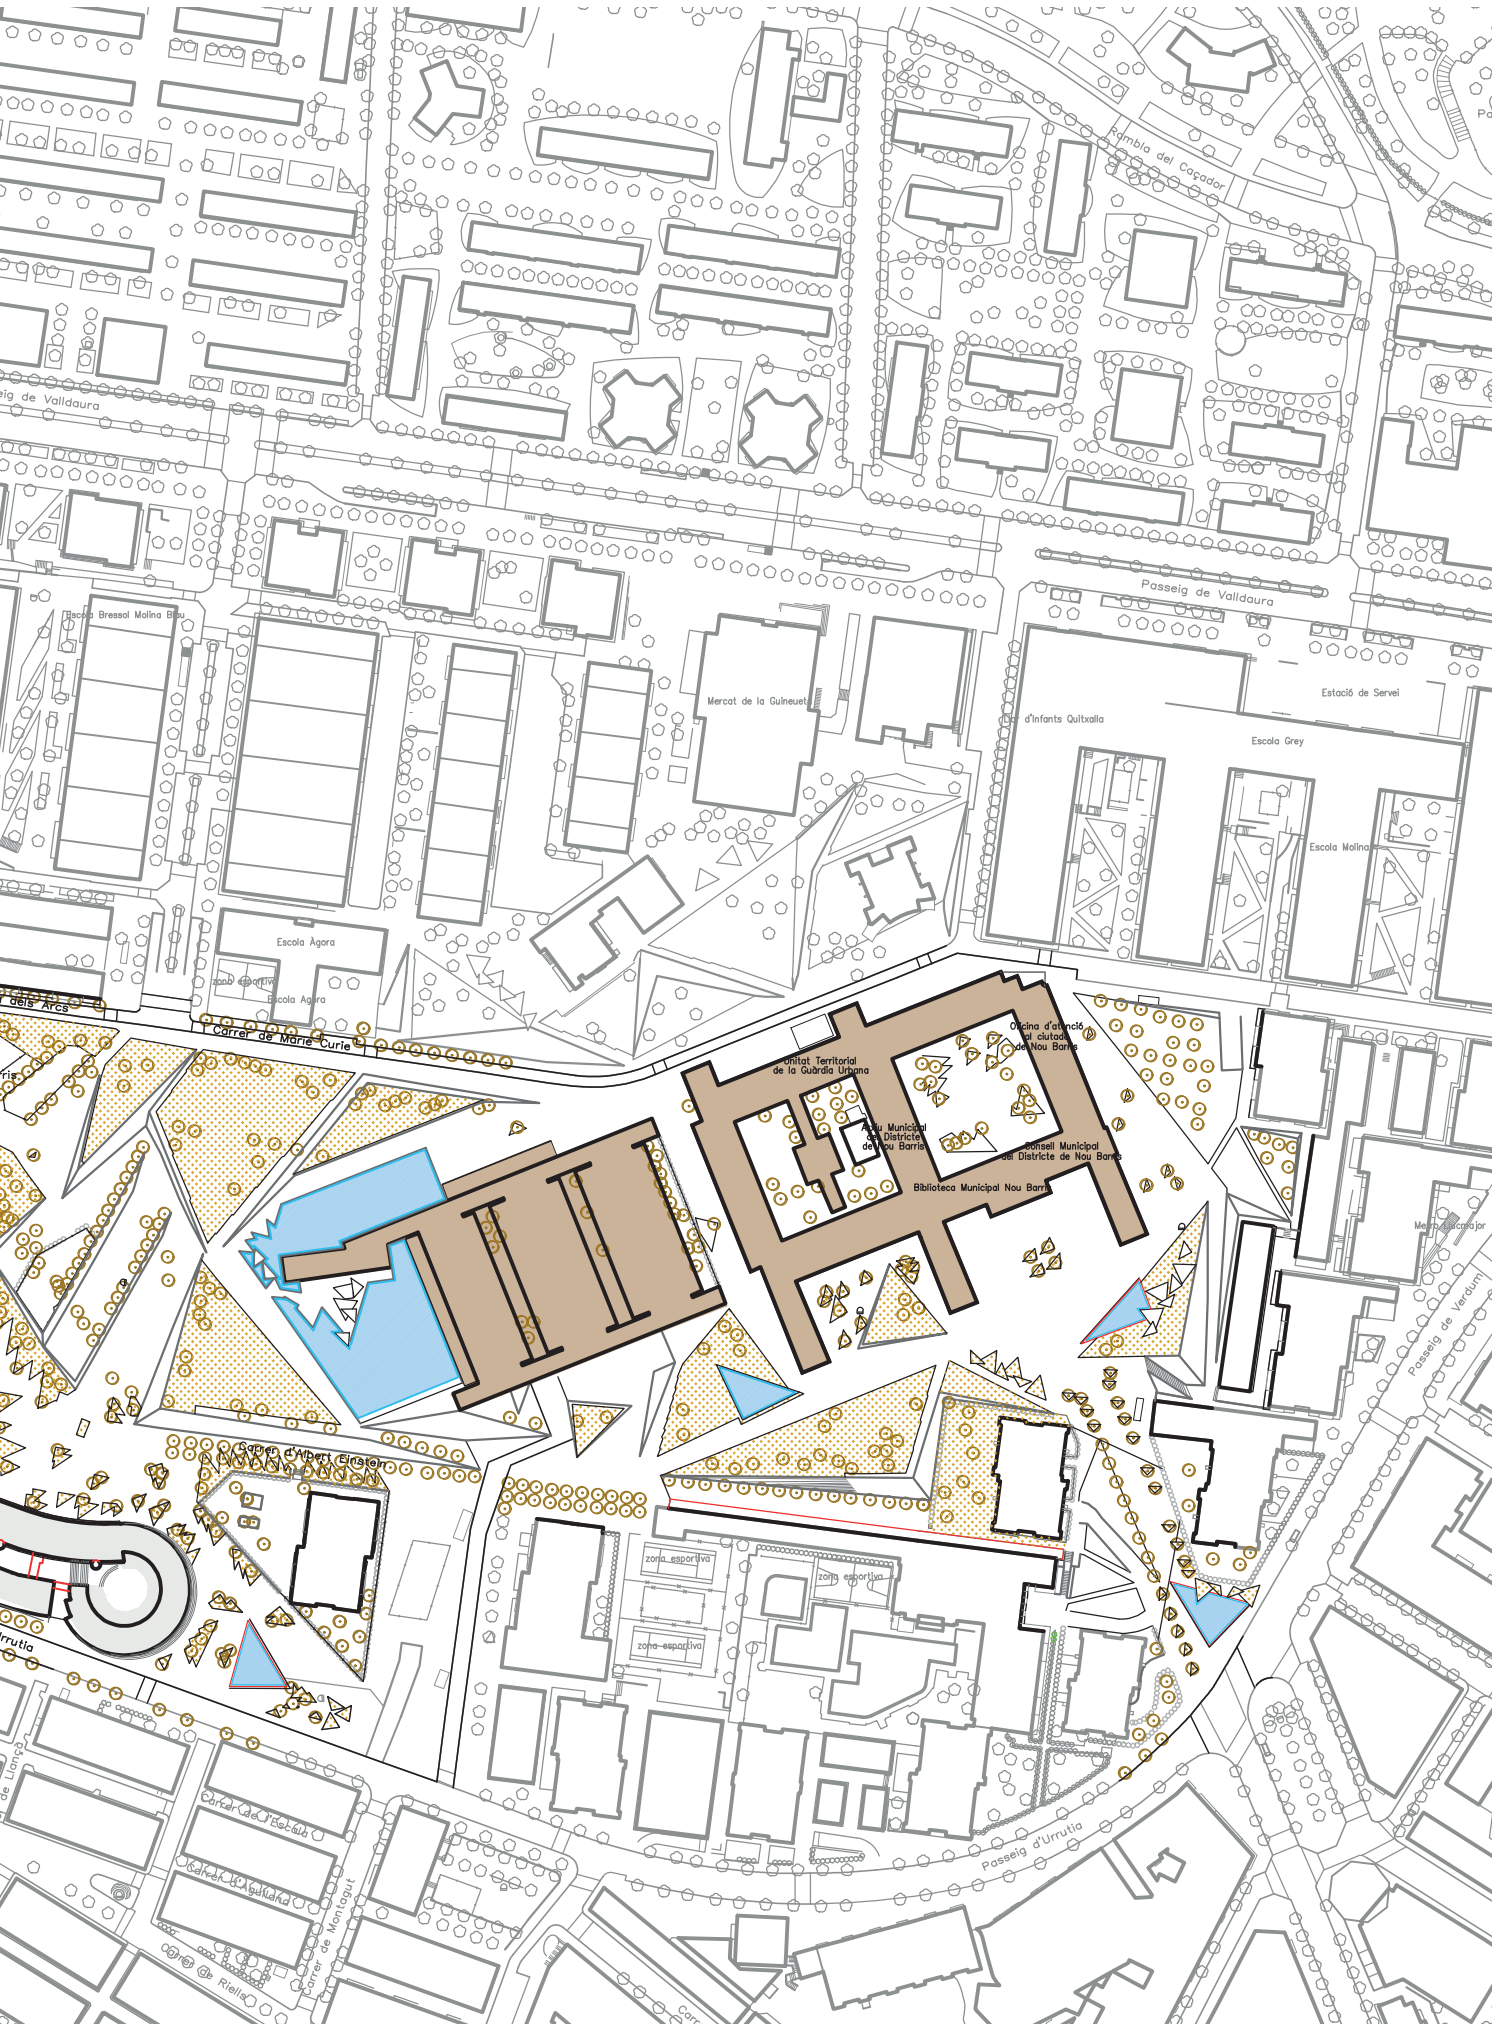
Planta del Parc Central de Nou Barris. Plànol d'elaboració pròpia sobre el material de Arriola i Fiol arquitectes
